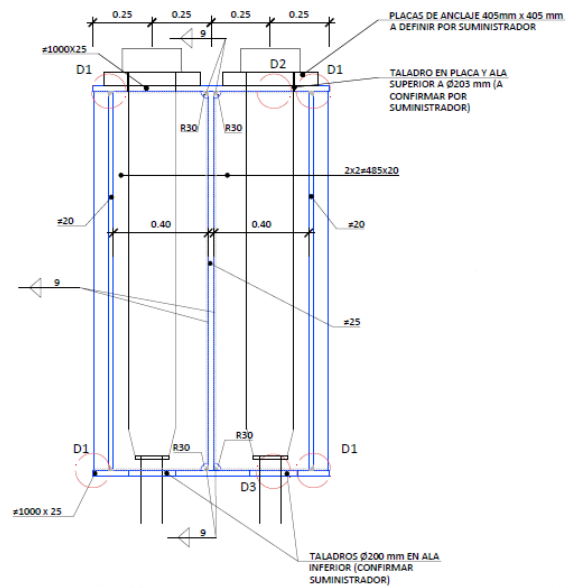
Sección de los rigidizadores bajo los anclajes del pretensado.
